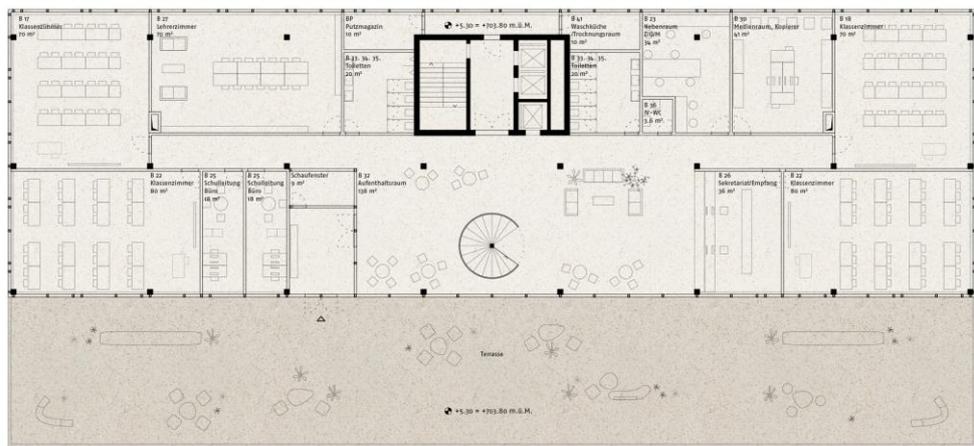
Grundriss 1. Obergeschoss «Retica»
